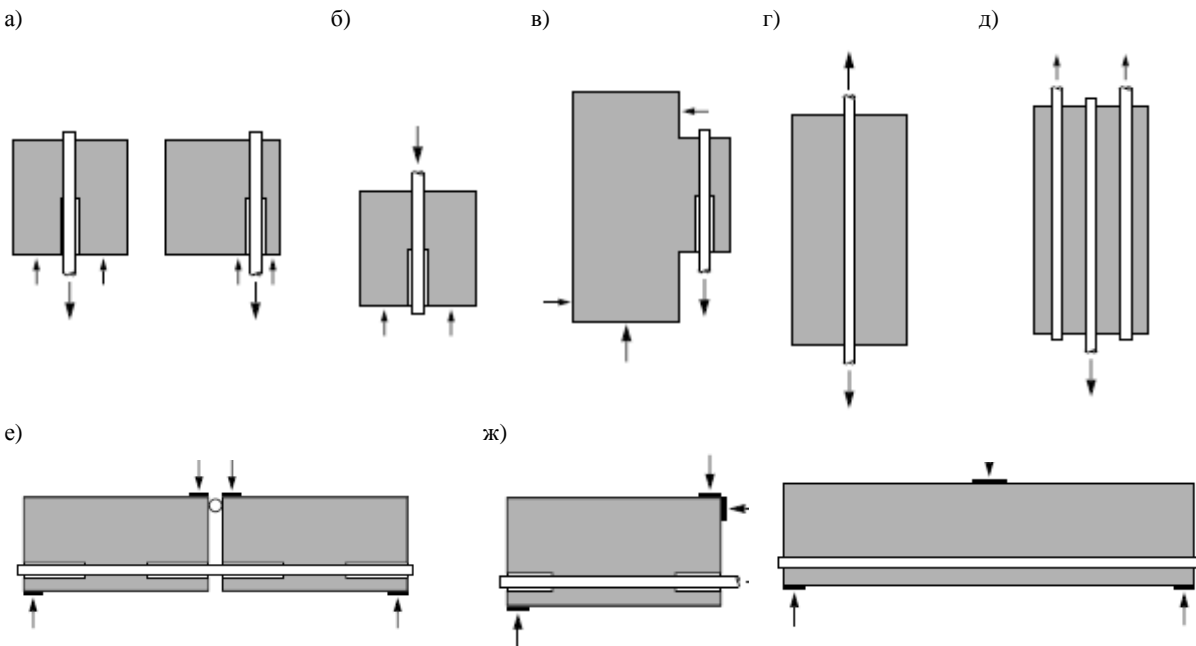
Основные виды экспериментальных образцов и схем испытаний при исследовании сцепления арматуры с бетоном [10]: а) выдергивание арматурного стержня; б) вдавливание арматурного стержня; в) консольный образец с вытягиваемым арматурным стержнем; г) растягиваемый образец с одним арматурным стержнем; д) образец с 3-мя с вытягиваемыми арматурными стержнями; е) изгибаемый образец; ж) балочный образец
